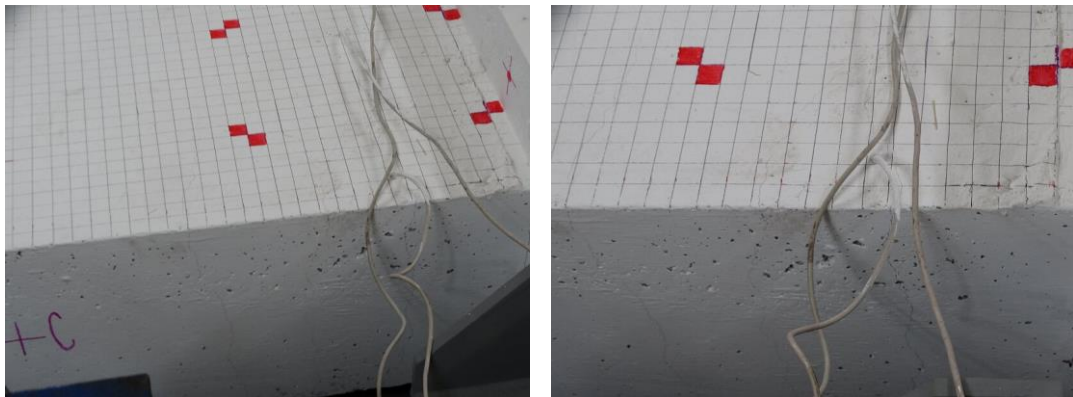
Primeras apariciones de grietas diagonales (*E - 1*).
